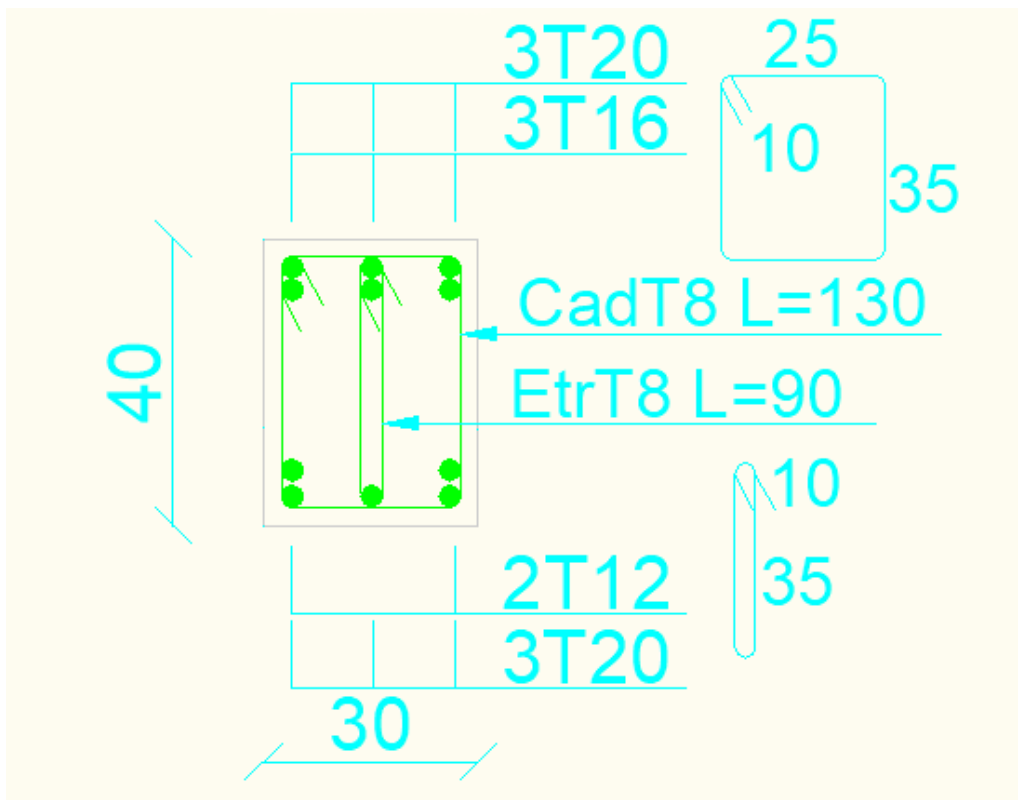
Schéma de ferrailage poutre secondaire Niv 6 sur appuis.
